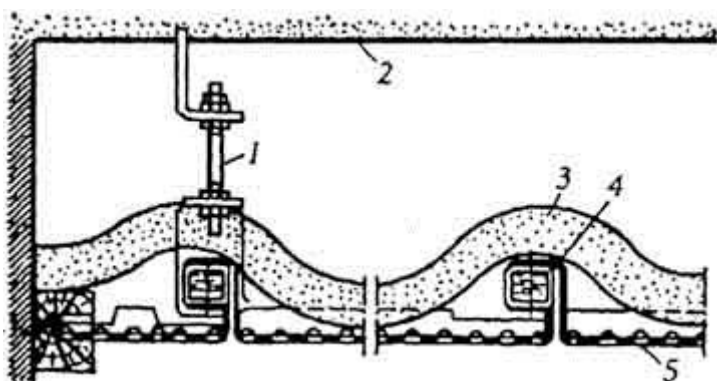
Подвесная потолочная отопительная панель: 1 - подвеска; 2 - перекрытие; 3 - тепловая изоляция; 4 - труба для теплоносителя; 5 - перфорированный металлический лист
